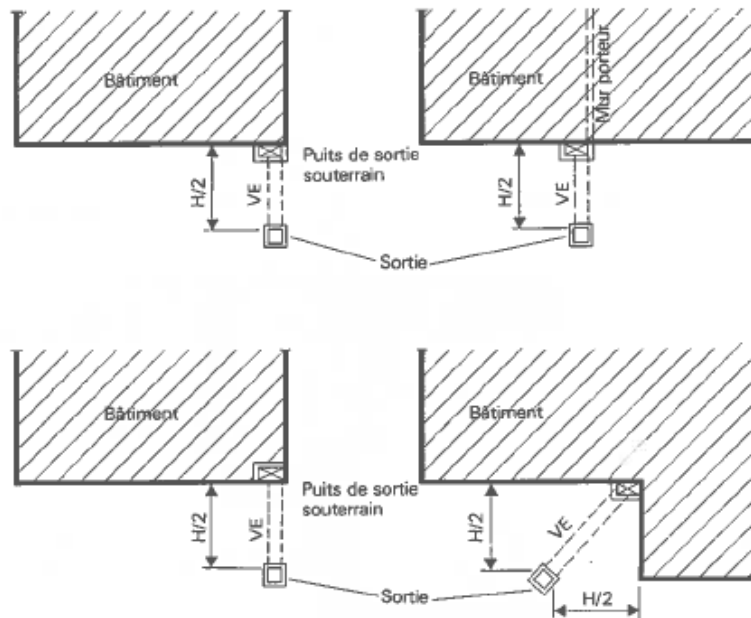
Disposition du puits de sortie dans le cas d'un abri en profondeur (vue en plan)
